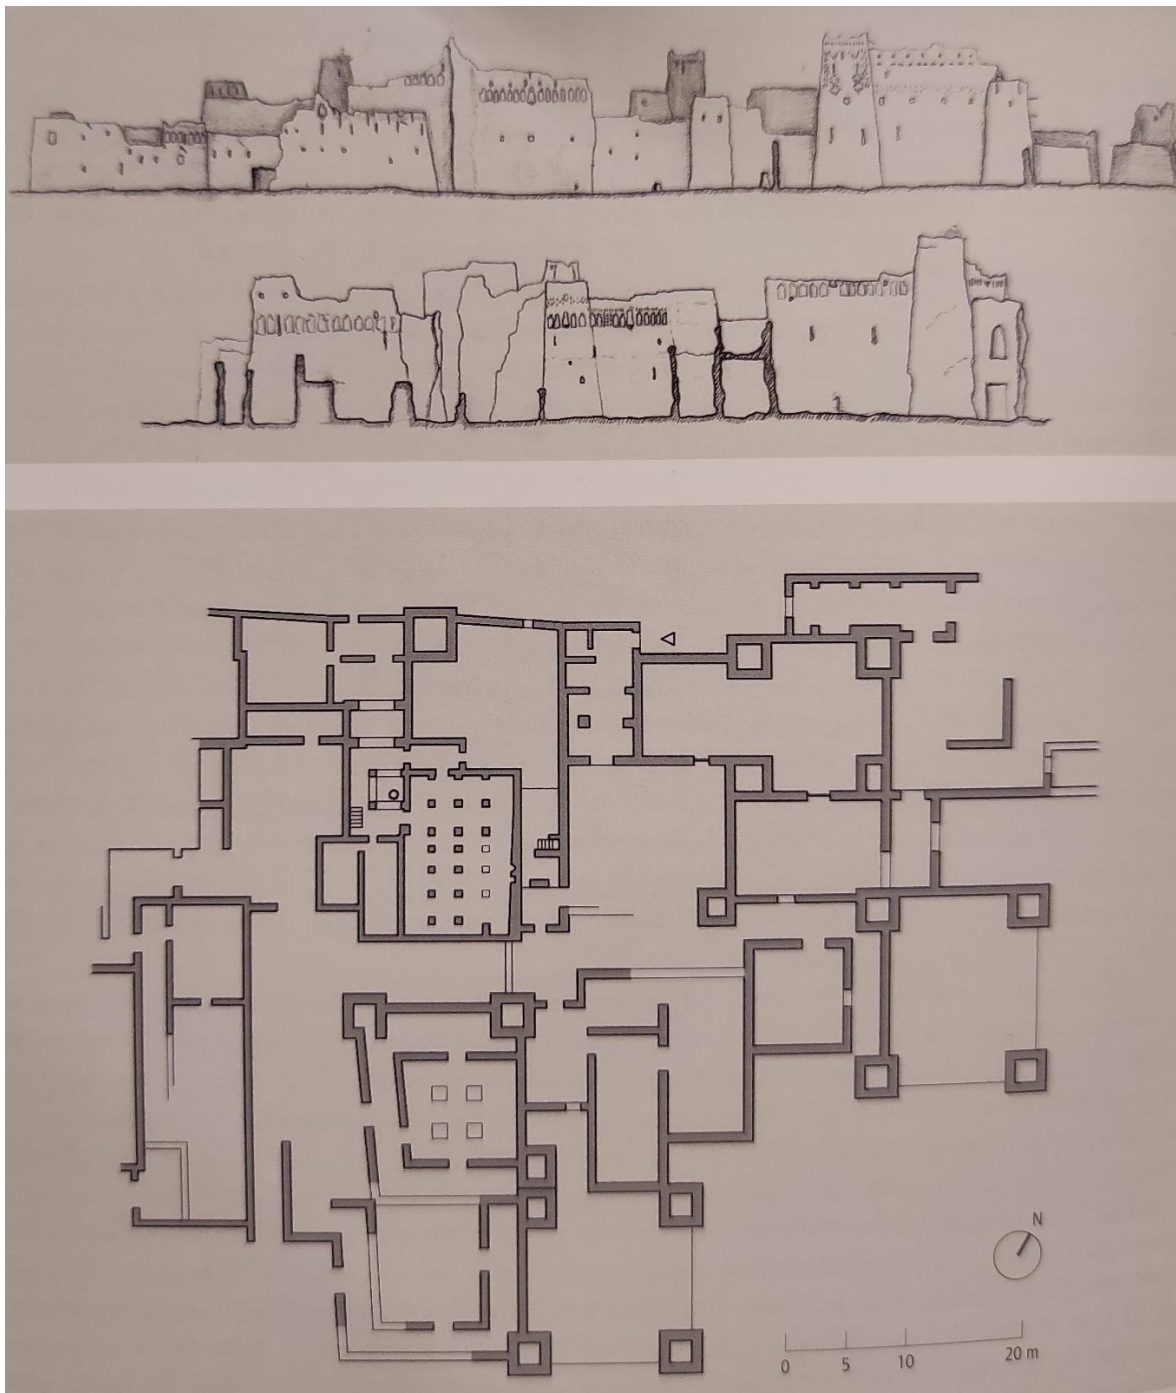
ksar Ait Said Ou Mansour croquis de los alzados norte y planta del estado actual-Marruecos-
